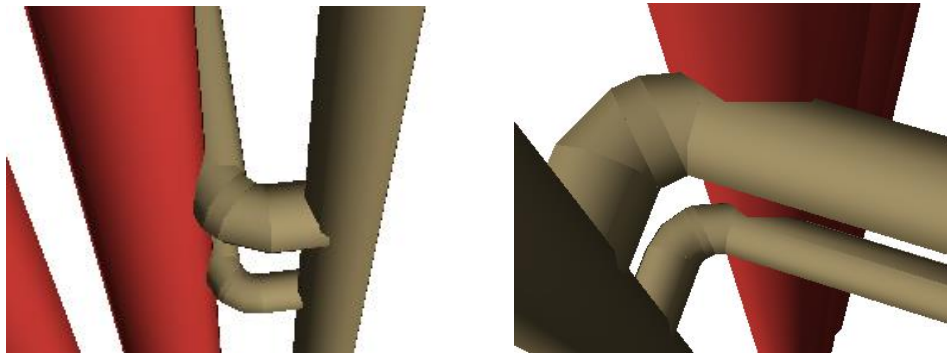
Conflito entre Rede Pluvial e Rede de extração
